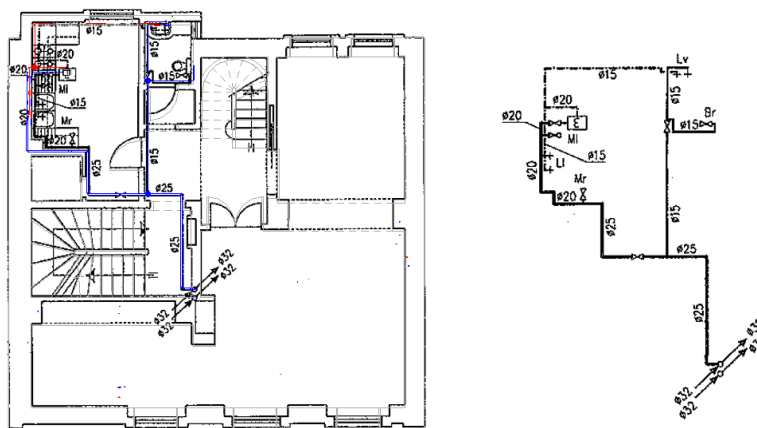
Modelo de abastecimento de água: planta de trabalho do piso 2
